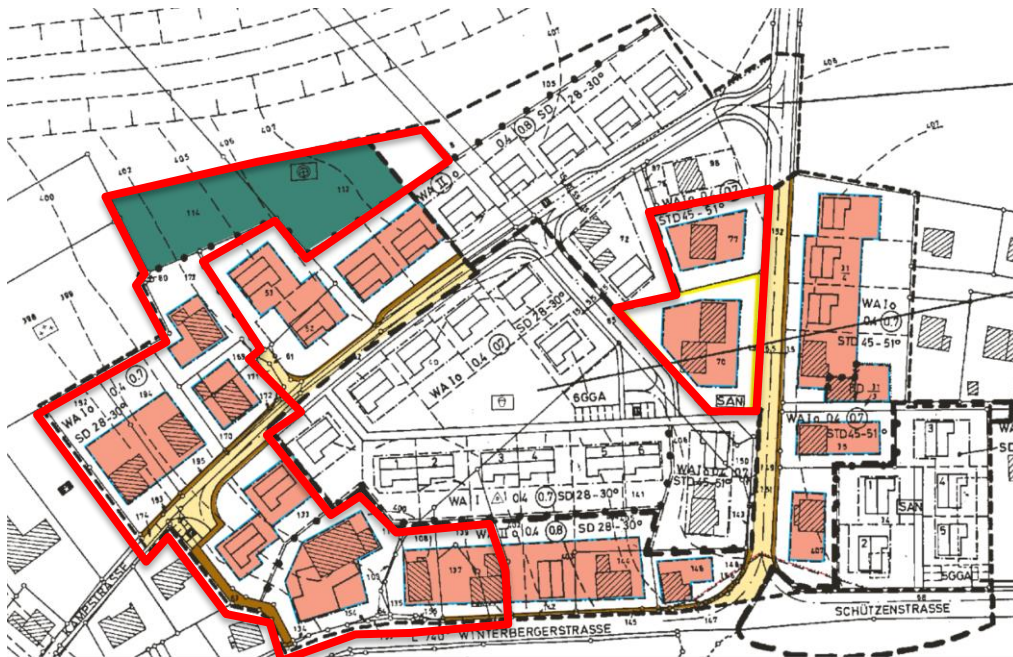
Ursprungsbebauungsplan 1974 (Änderungsbereich der 4. Änderung in rot eingefasst)
